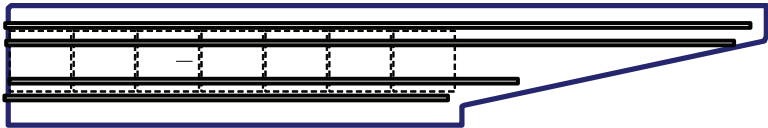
Répartition du ferrailage horizontal – dalle pleine
